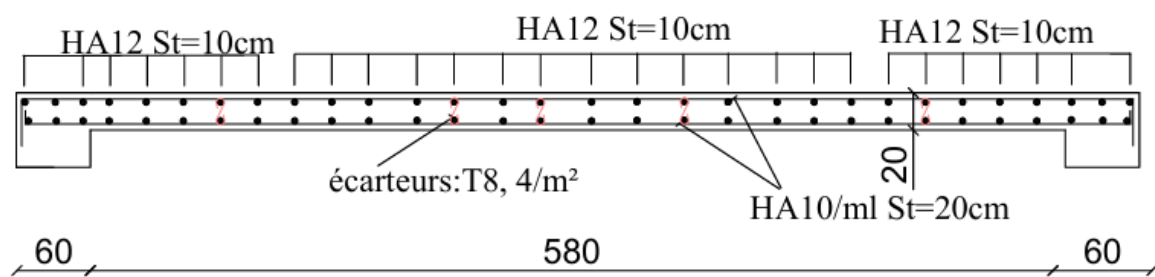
Schéma de ferrailage des voiles (Sens X-X)
